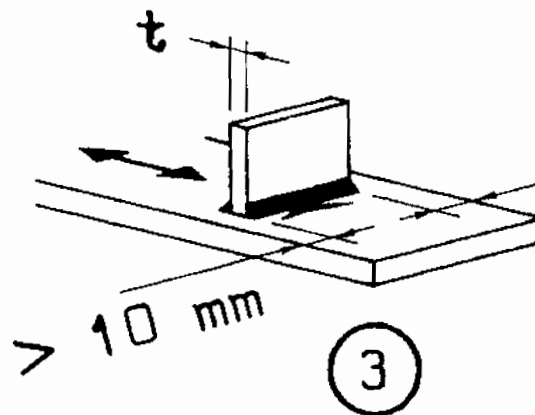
Konstruktionsdetail 3 in „Nichttragende Schweißnähte“ Eurocode 3 / 14 / Kerbgruppe 80 bzw. 71
